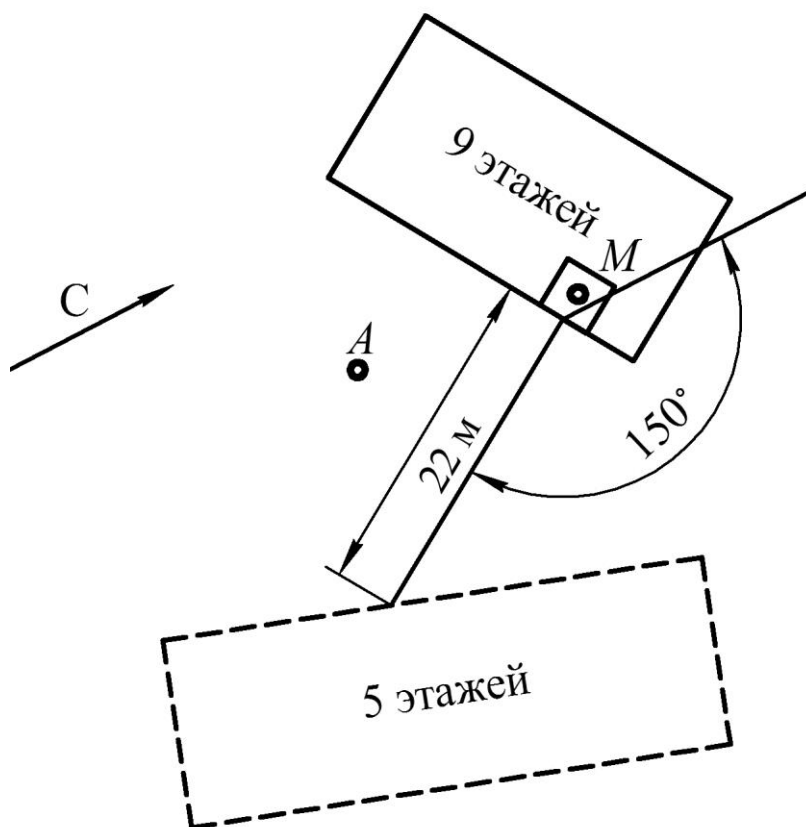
Генплан к разделу «Светотехнический расчет помещения» (М 1:500)
